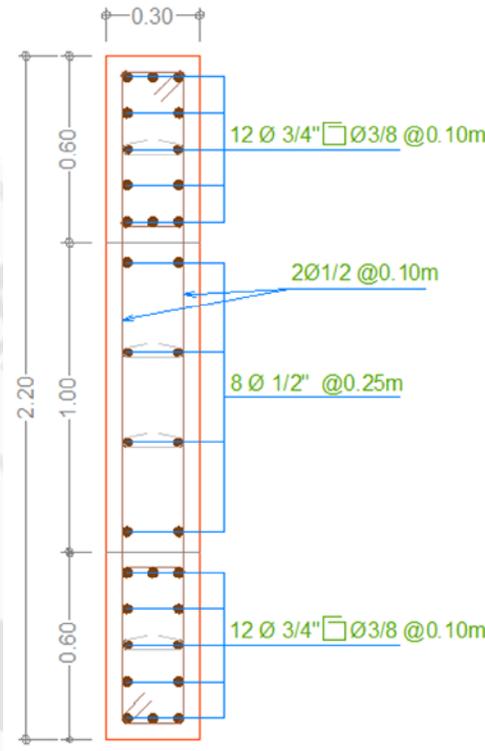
Diseño Final de la Placa Analizada PL-05.
